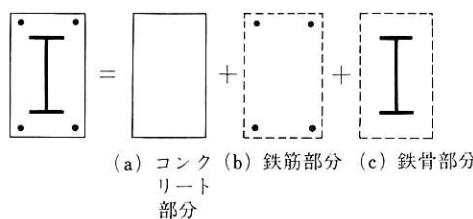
鉄骨鉄筋コンクリートの断面構成
